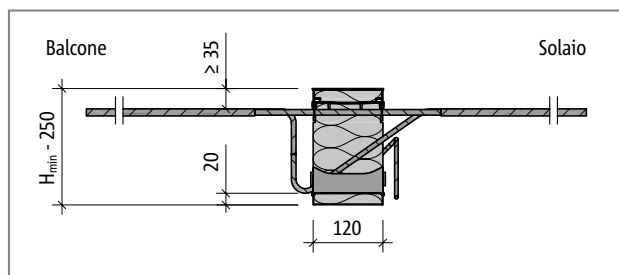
Schöck Isokorb® tipo KXT55 - KXT100: sezione dell'elemento
